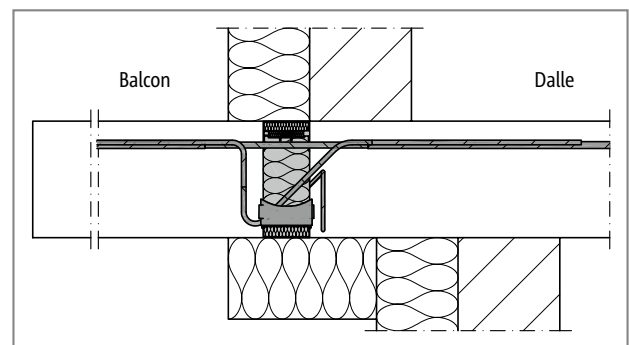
Schöck Isokorb® T Type K-E, K-T : Raccordement pour plancher indirect et ETICS
